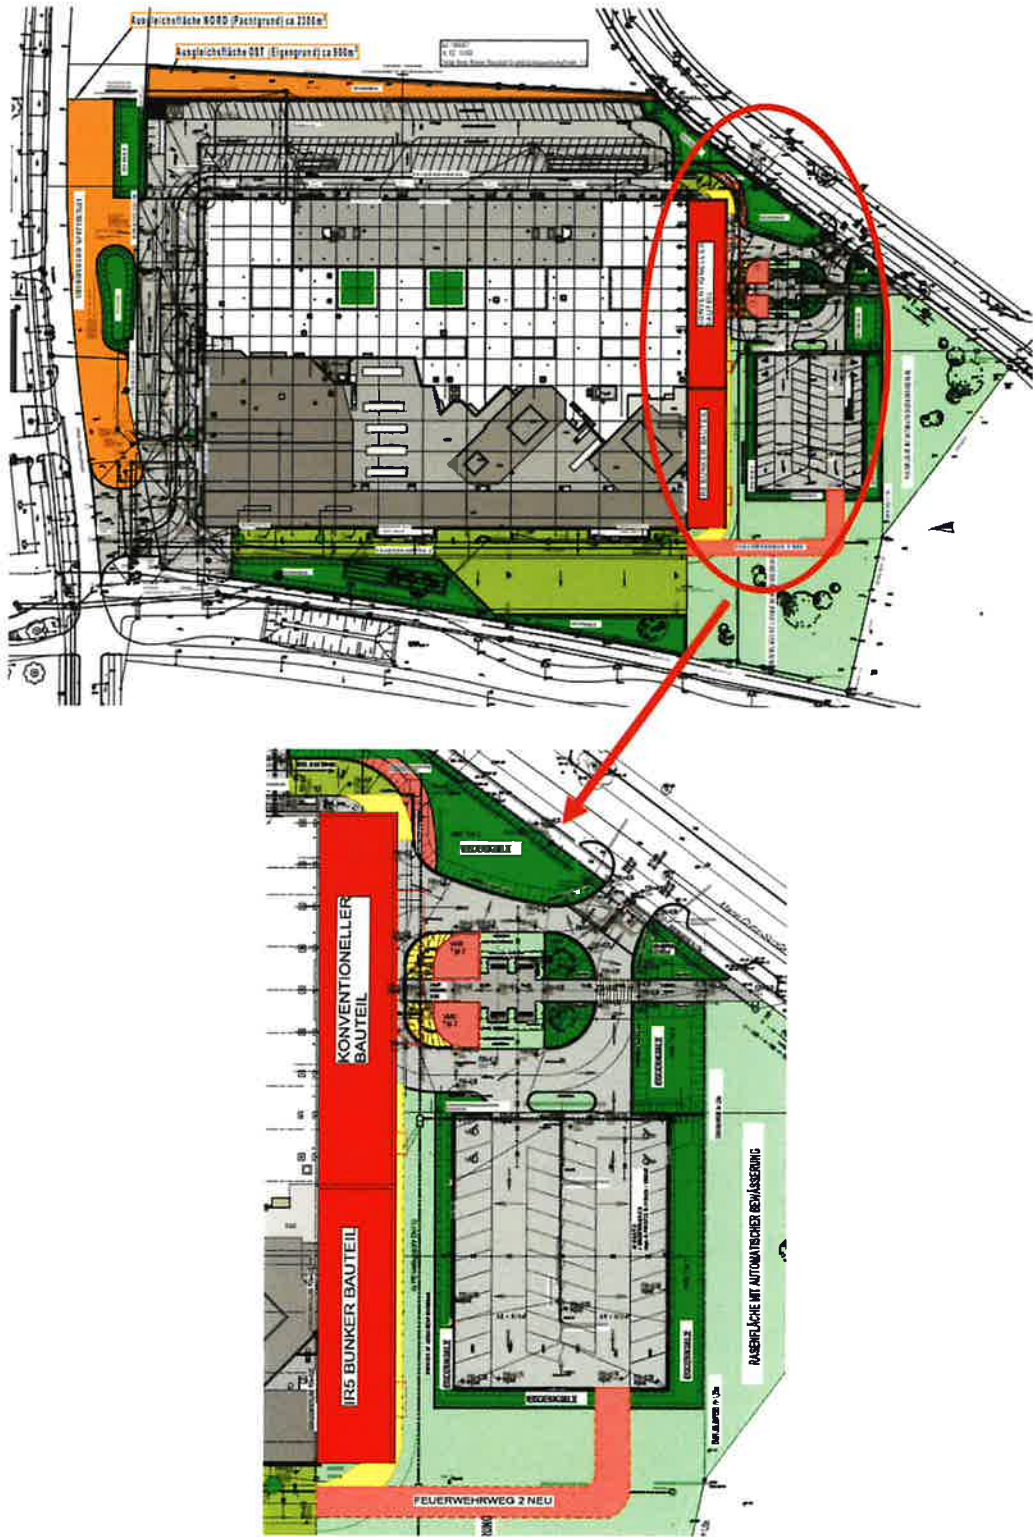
Bestehende Anlage MedAustron und Verortung des geplanten Zubaus mit den beiden Bauteilen farblich in Rot dargestellt. Details können dem Plan „B.03-01 P01 1.0 A Grundriss Erdgeschoss“ entnommen werden.
